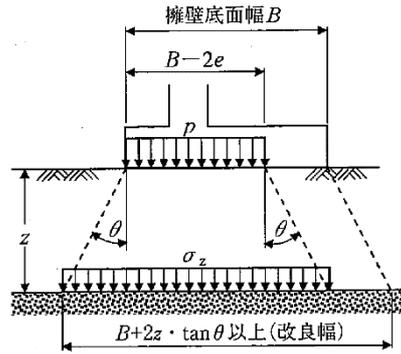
地中での地盤反力度と改良幅⁸⁾
